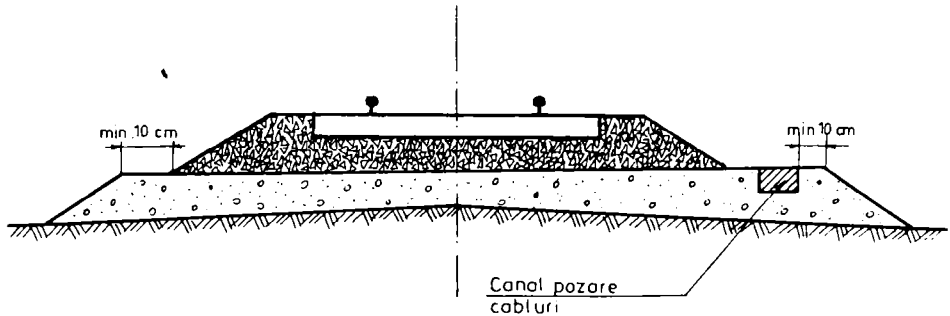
Alcătuirea generală a substratului căii pe linii cu și fără canale prefabricate din beton pentru pozarea cablurilor.
